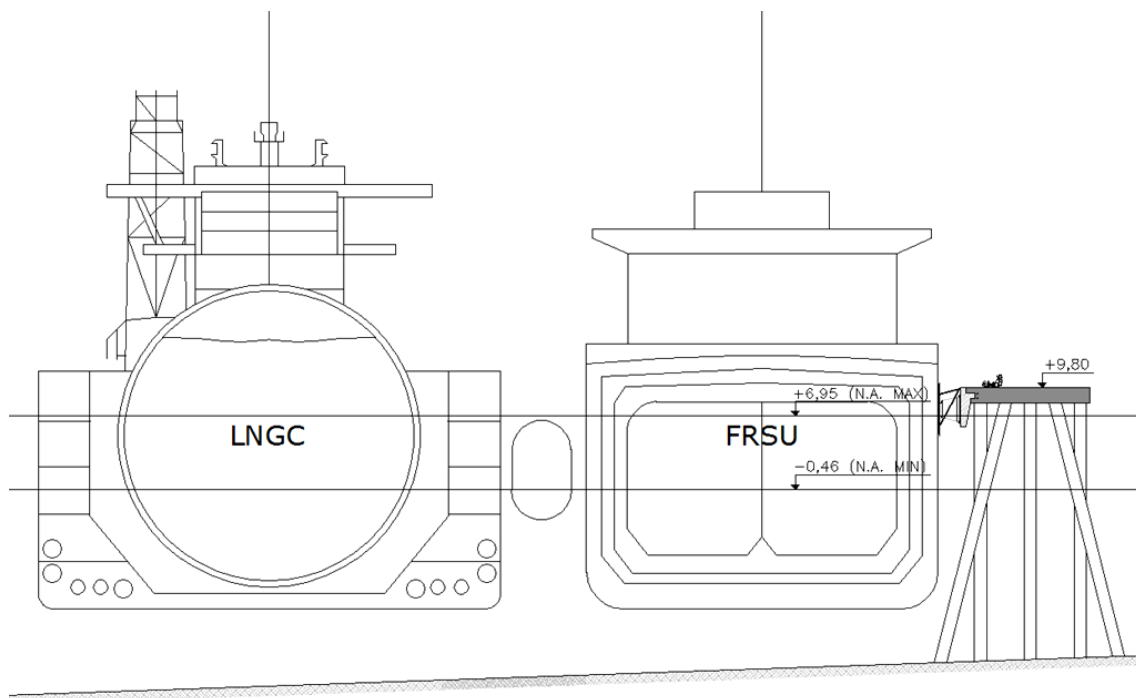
Corte do Pier de atracação (ship-to-ship). Fonte: LC Terminais (2025).
